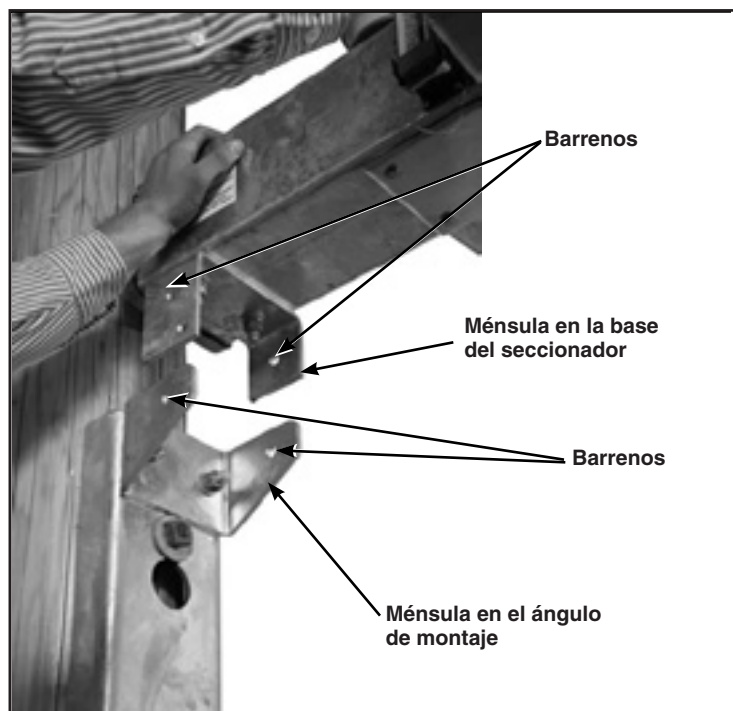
Eleve el seccionador hasta la altura de montaje y alinee los barrenos con cuidado.
